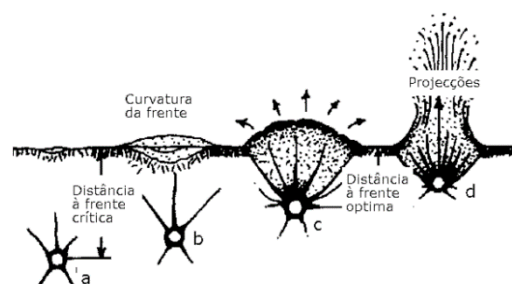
Afastamento crítico (retirado de Galiza et al., 2008)
